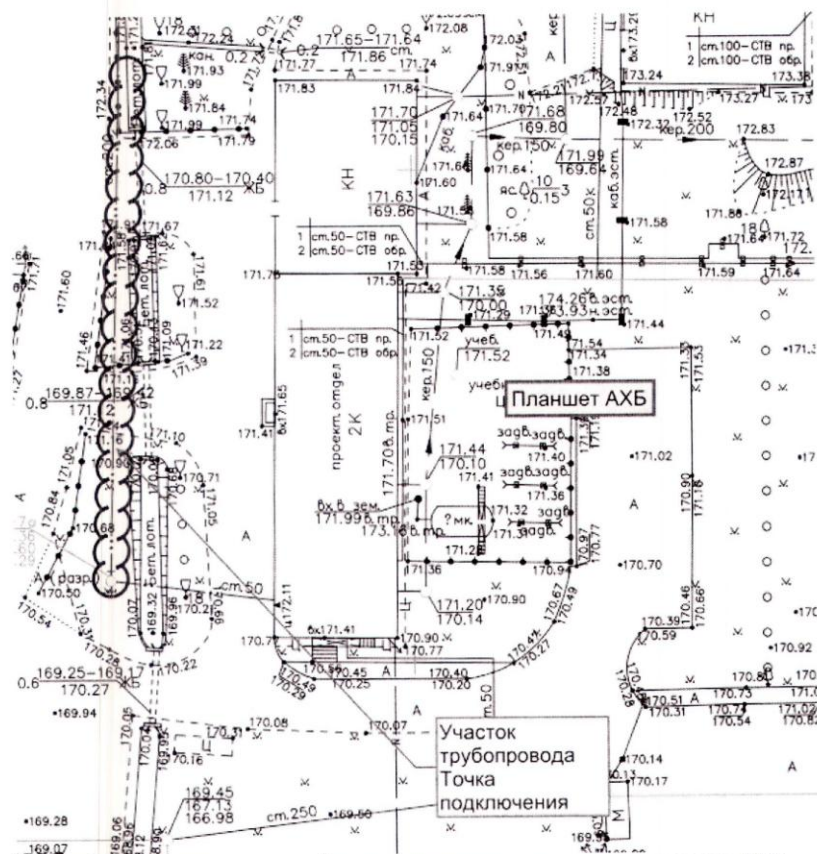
Схема подключения сетей к противопожарному водопроводу на планшете АХБ.
